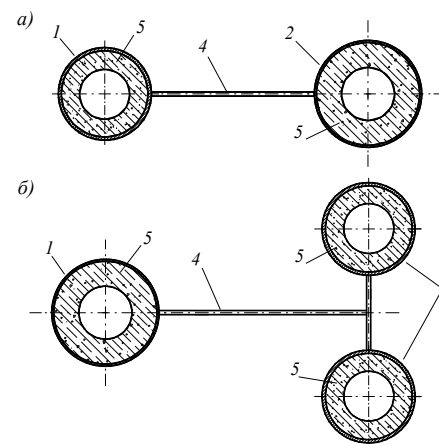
Поперечные сечения подкрановой части внецентренно сжатых трубобетонных колонн с однотрубной (а) и двухтрубной подкрановой ветвью (б):
